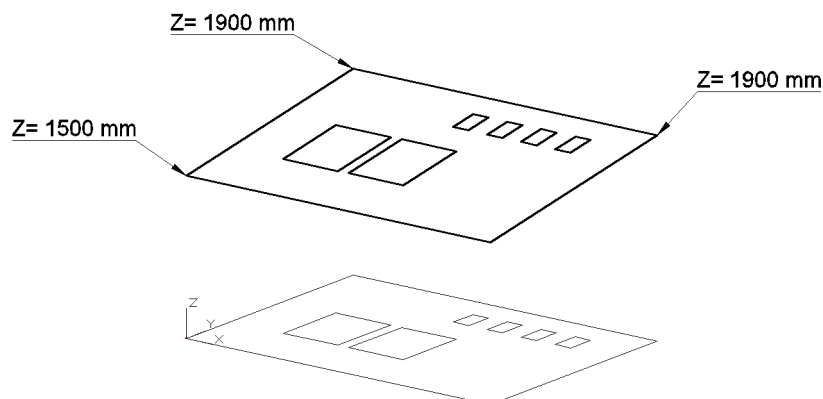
Grundrissfläche und projizierte Fläche im Raum
